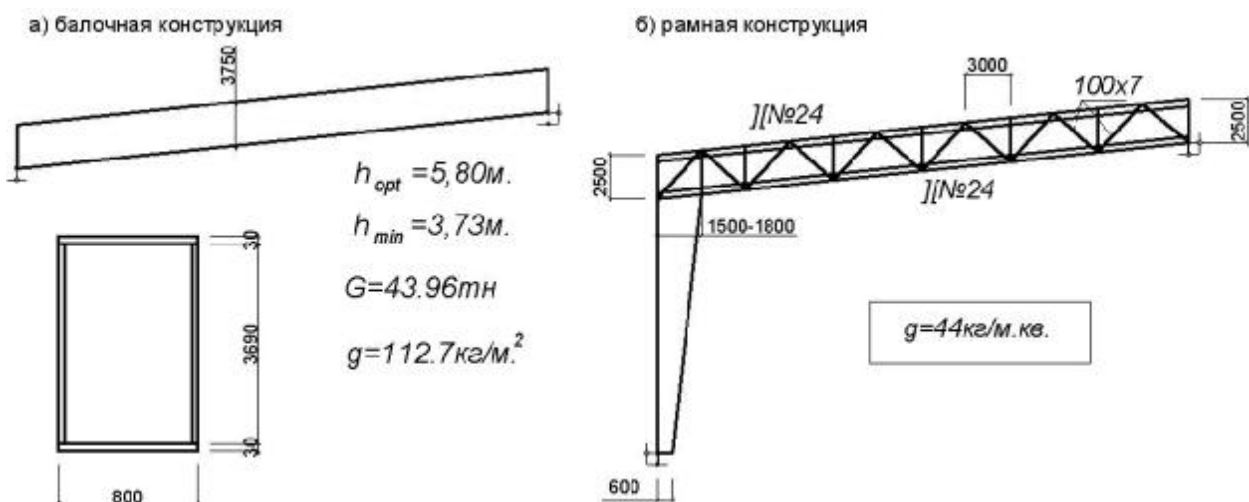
Варианты конструктивных схем: а) балочная, б) рамная конструкция
